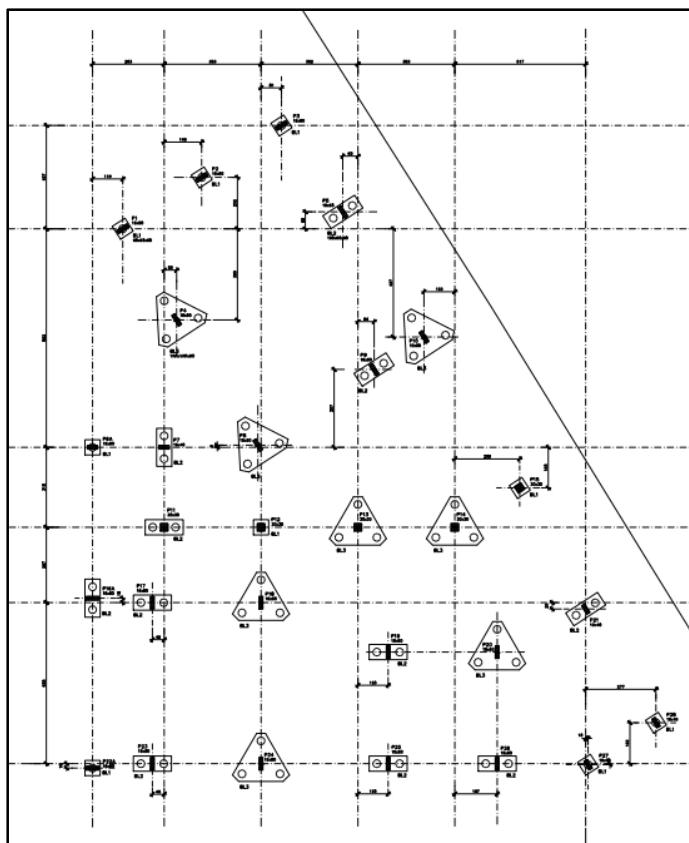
Planta de locação blocos de fundação – Prédio Escolar – 2ª Etapa
